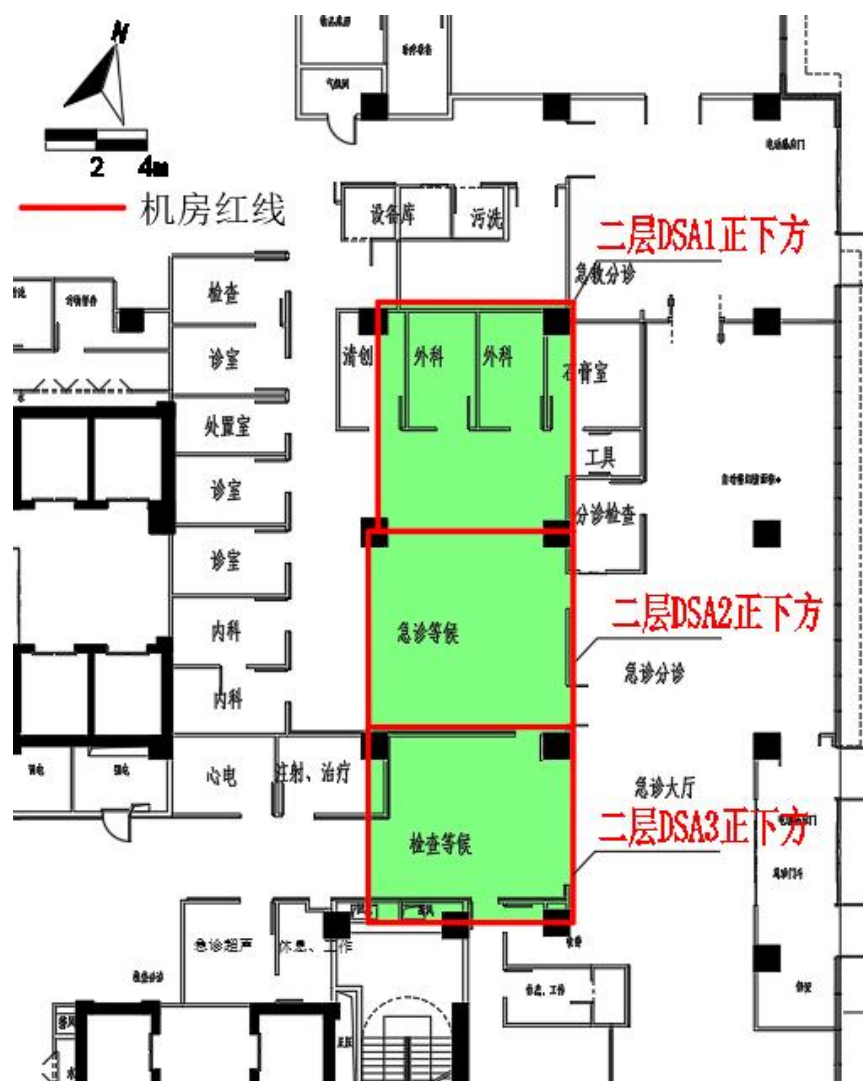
本项目 DSA1、2、3 下方楼层（一层）局部平面布置示意图
